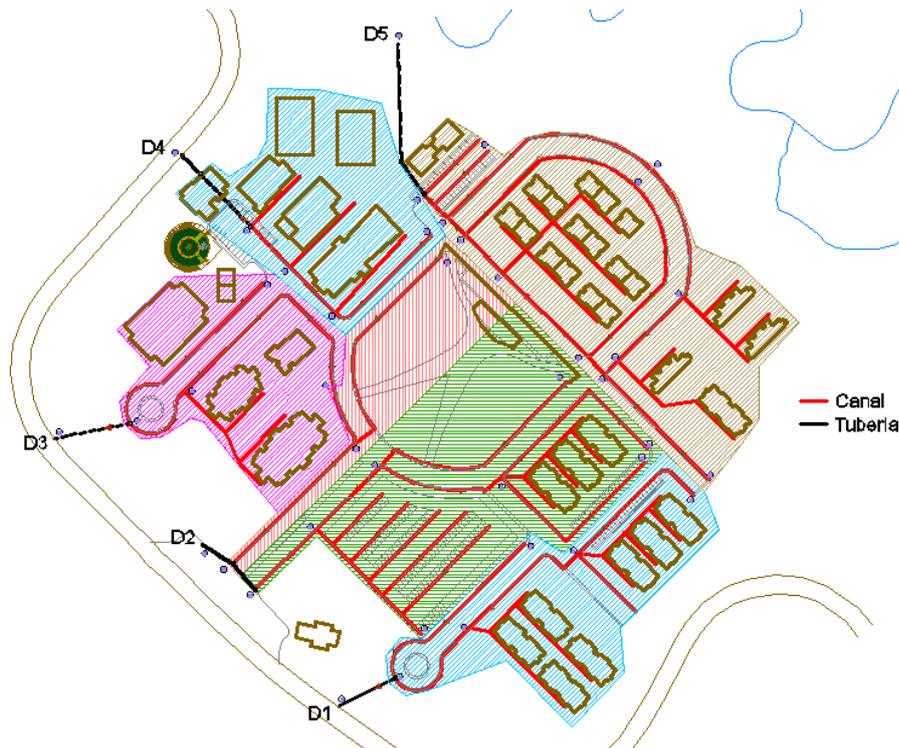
Ubicación de descargas con sus áreas de drenaje del campamento de operación
